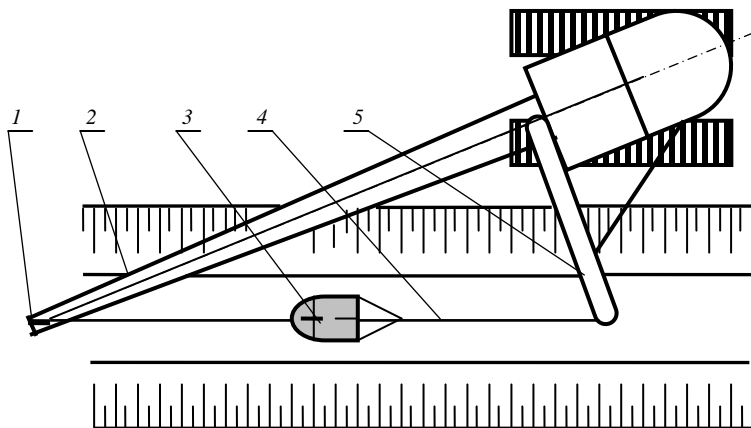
Схема работы бокового драглайна: 1 – поворотный головной блок; 2 – стрела; 3 – ковш; 4 – канаты; 5 – боковая стрела
